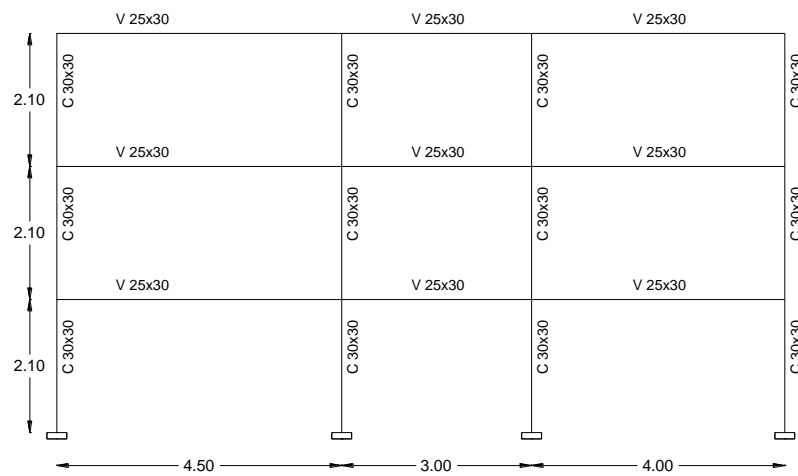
Vigas y Columnas asignadas al Pórtico para el análisis en el plano.
